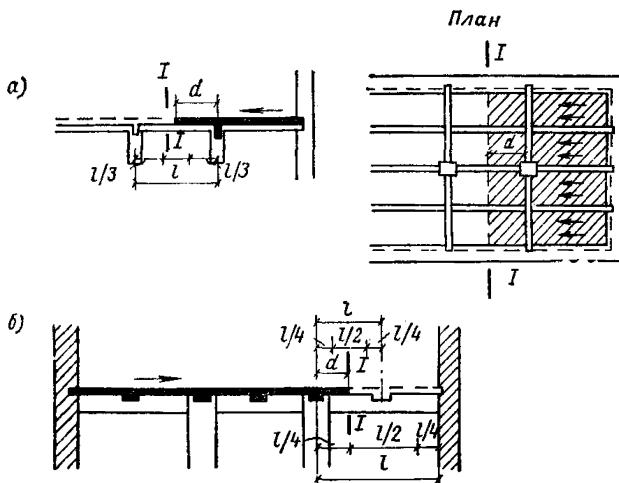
Расположение рабочих швов при бетонировании ребристых перекрытий
